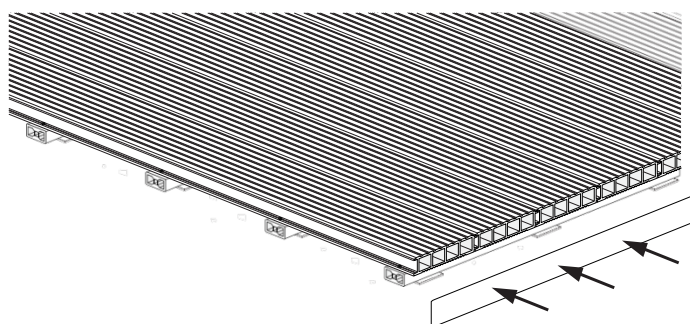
Окончание укладки бесшовной террасной доски Holzhof
